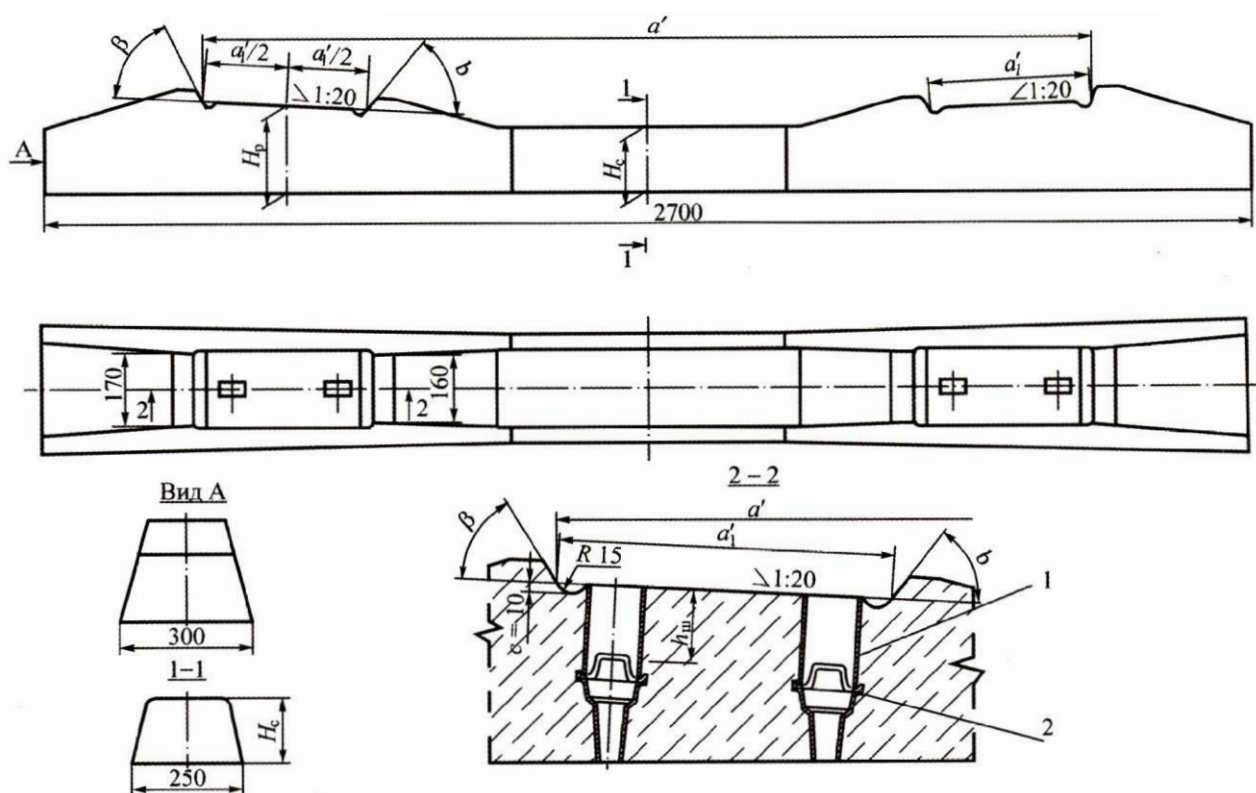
Общий вид железобетонной шпалы Ш3:
